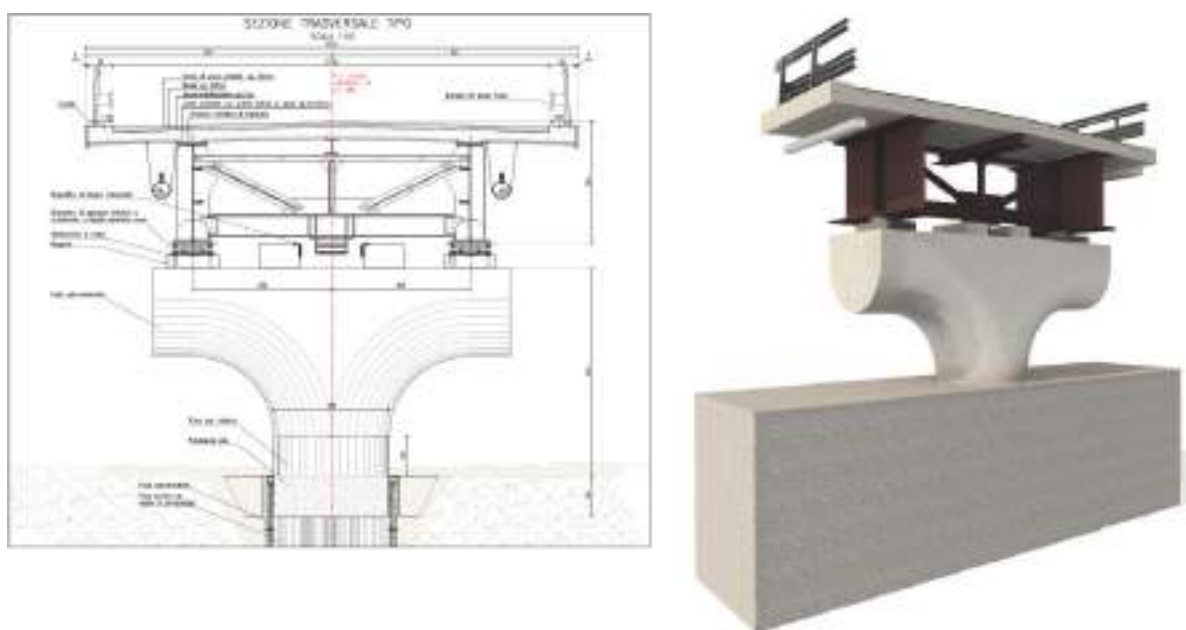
Carpenterie pila e impalcato: sezione e vista 3D.
